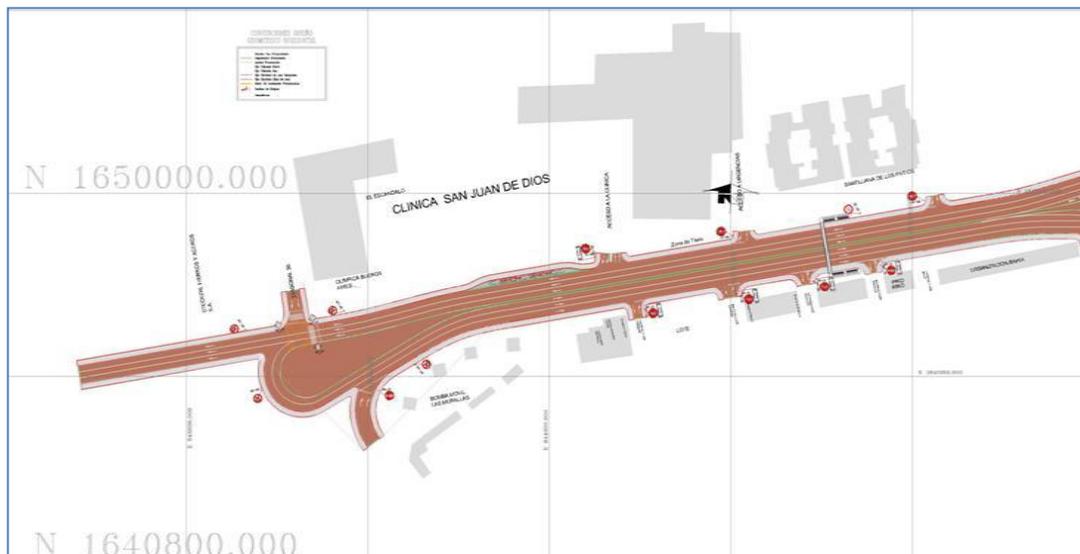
Planta Sector 1 – Transversal 54⁵⁰
